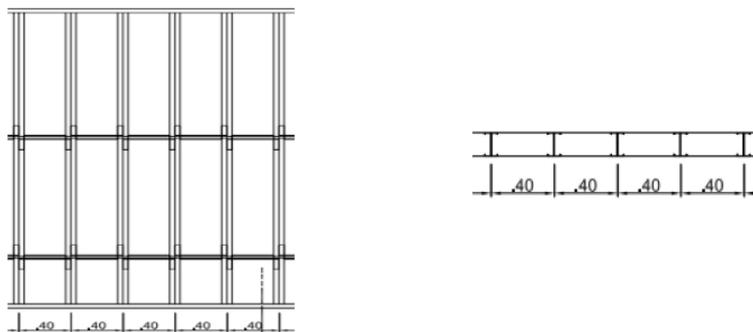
Vistas em planta (esquerda) e corte (direita) da estrutura do entrepiso formada por vigas de perfis tipo U enrijecido, guias de perfis tipo U simples e bloqueadores formados por perfis tipo U simples (dimensões em cm).
